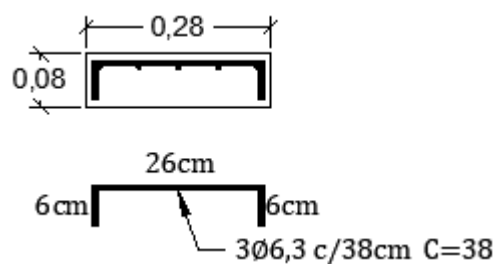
Corte transversal de um degrau da escada engastada com degraus isolados. Apresenta o detalhamento das armaduras de distribuição. As medidas estão apresentadas em metros (Fonte: autor).
